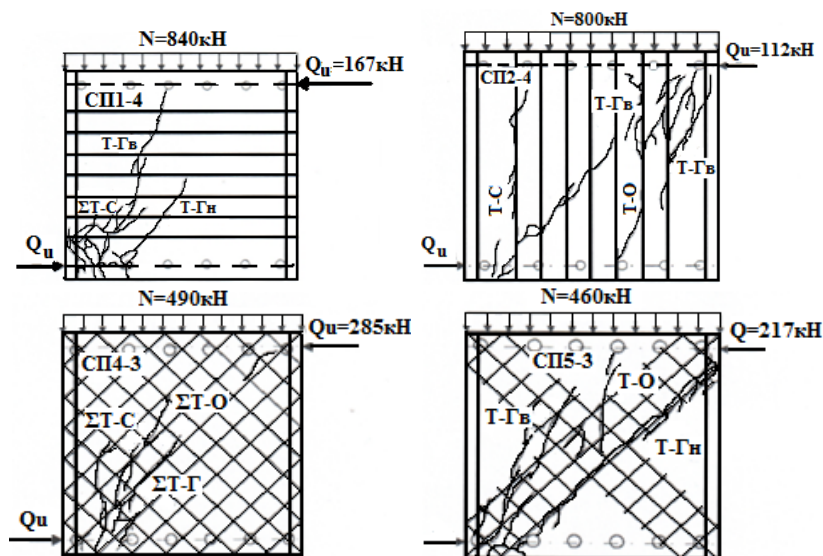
Схемы образования трещин в армированных моделях стен
